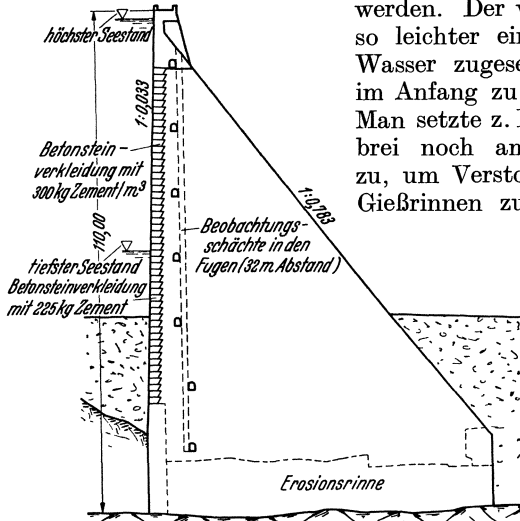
Betonsteinverkleidung der Wäggi-Talsperre (wasserseitig). Betonsteine: 1,4 m hoch, 2,05 → 2,58 breit.
